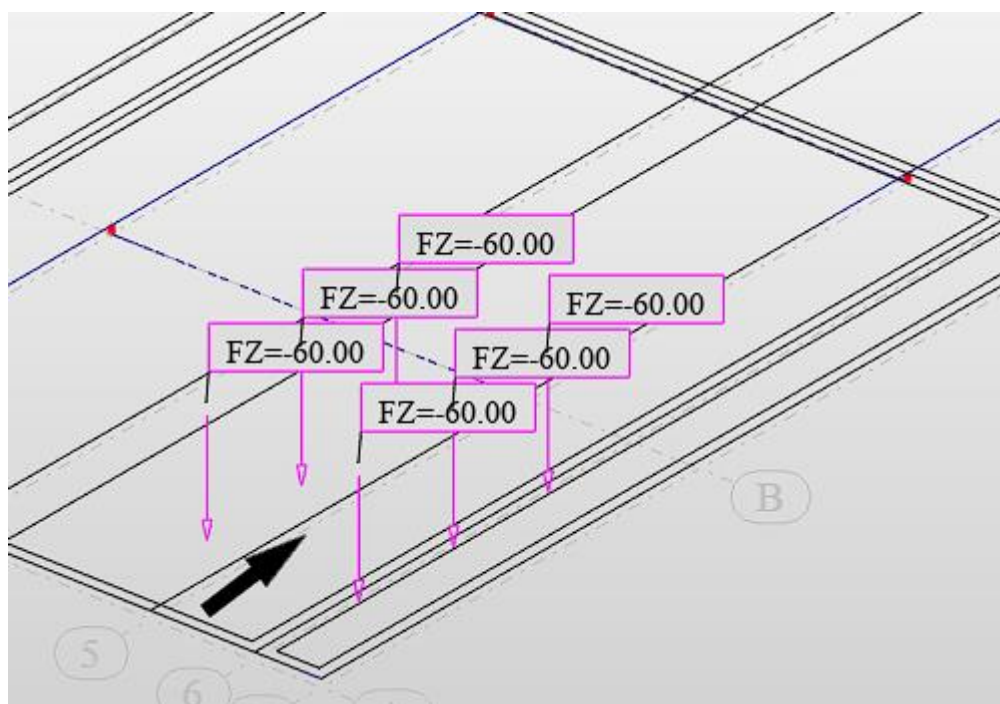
Aplicação de carregamento do veículo para análise de lajes da ponte 1
